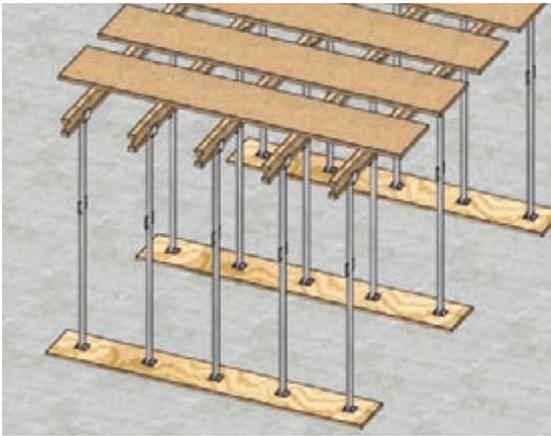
Pose et mise à niveau des planches ou bastaings
